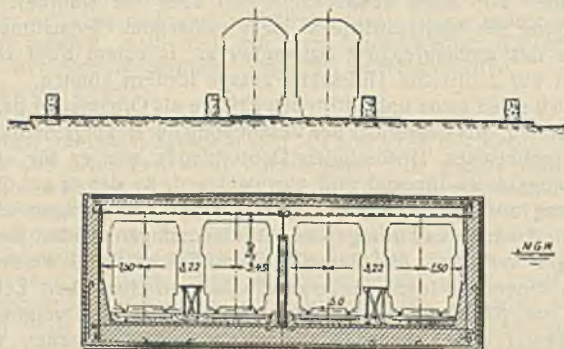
Querschnitt durch den Bahntunnel nördlich des Bahnhofes.
